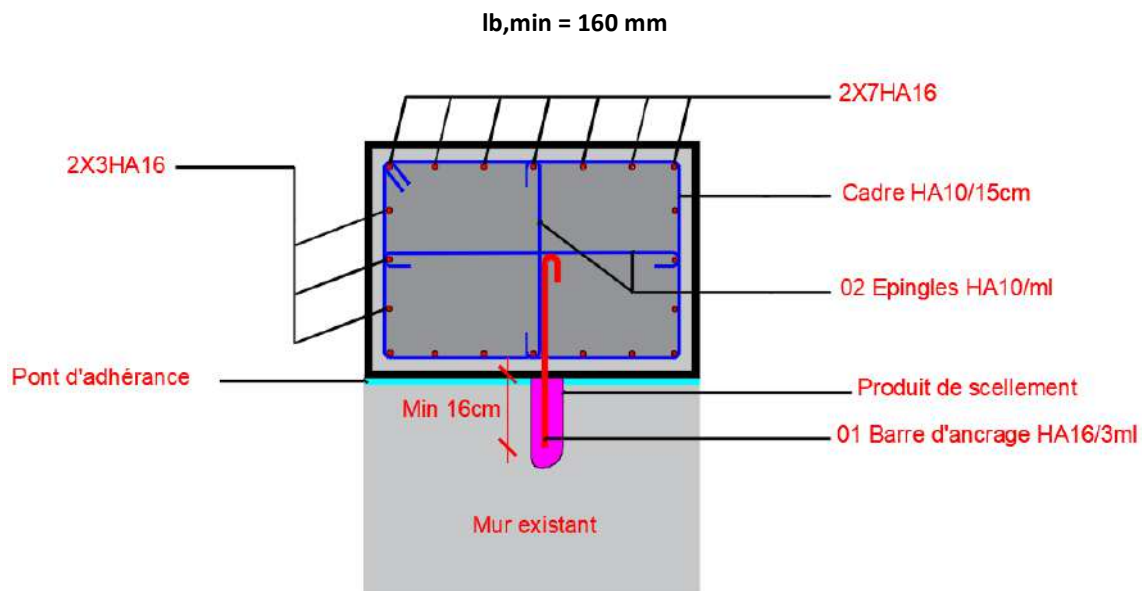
Principe de ferrailage de la poutre de couronnement du mur
